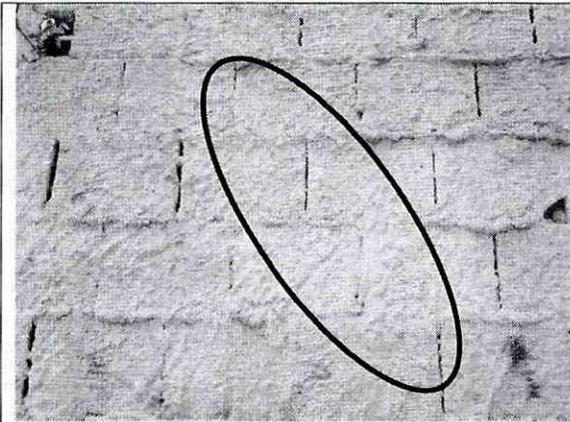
Fisuras siguiendo la línea de pega entre bloques.
